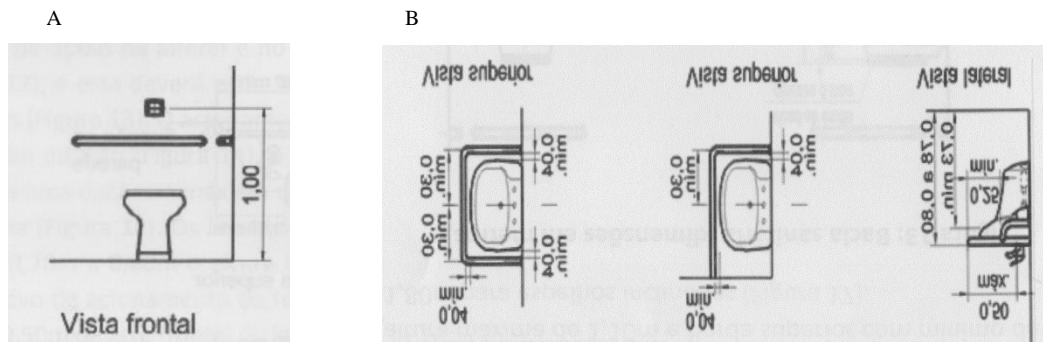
A: Acessórios (dimensões em metros); B: espelhos (dimensões em metros)
